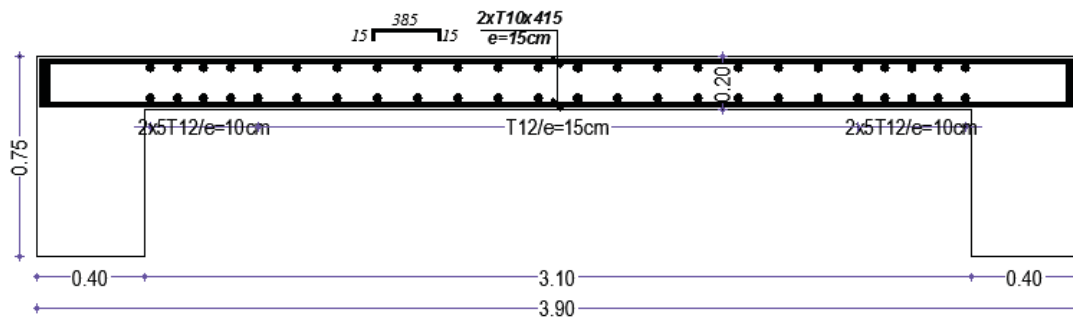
Dessin de ferrailage d'un voile de contreventement avec ouverture
